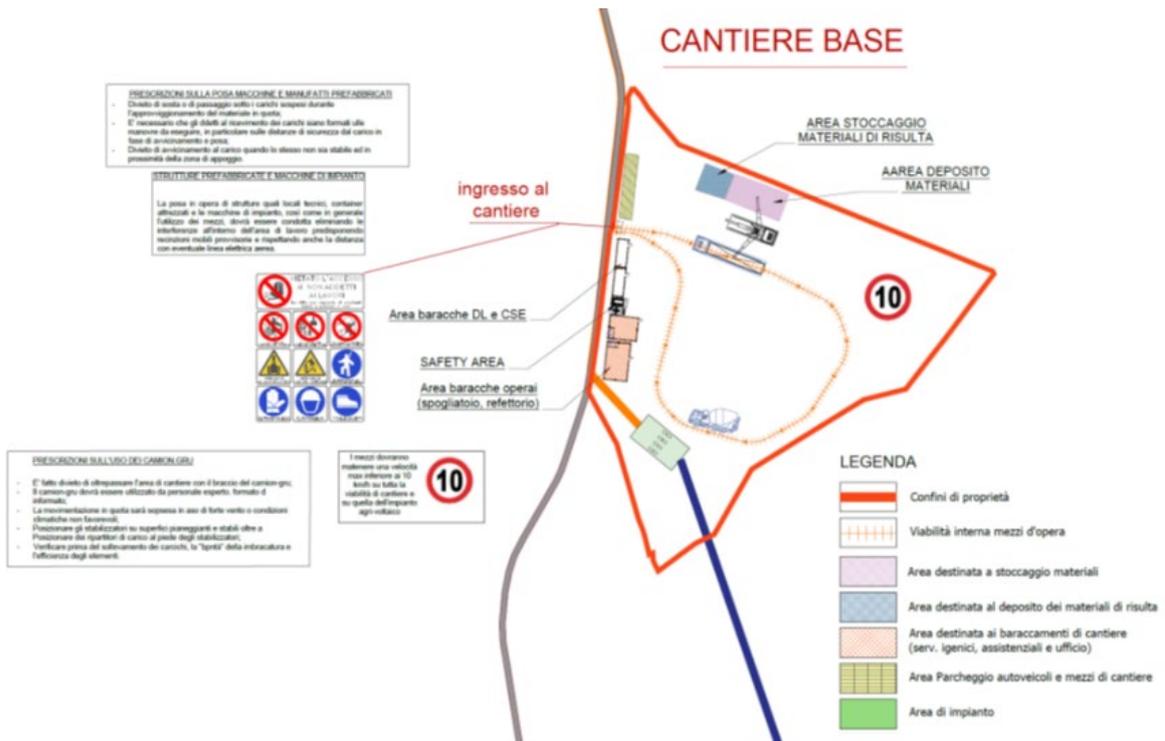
Dettaglio Cantiere Base (Campo Base).
